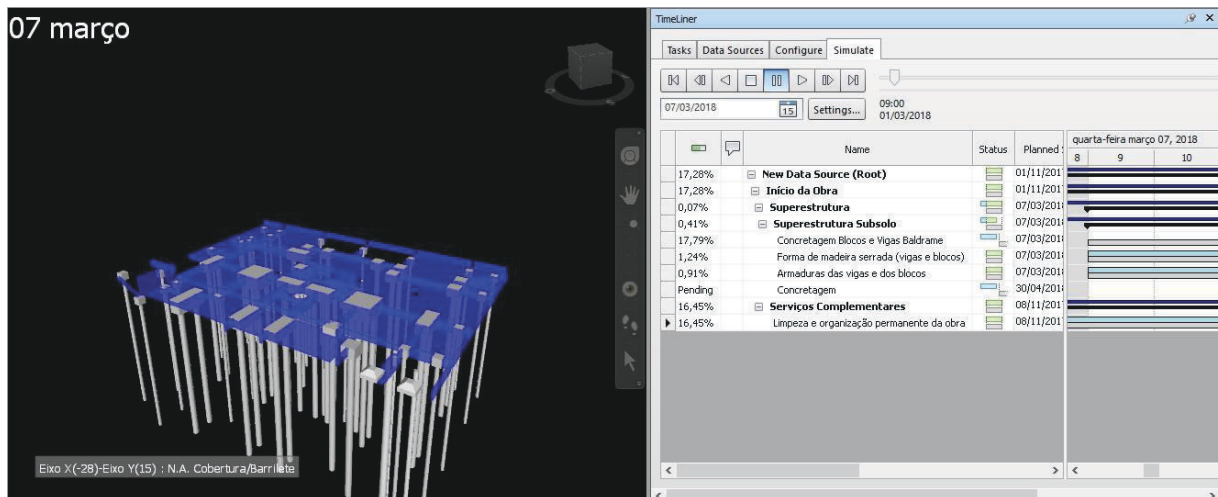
INICIO ADIANTADO DA CONCRETAGEM DOS BLOCOS E VIGAS BALDRAMES
